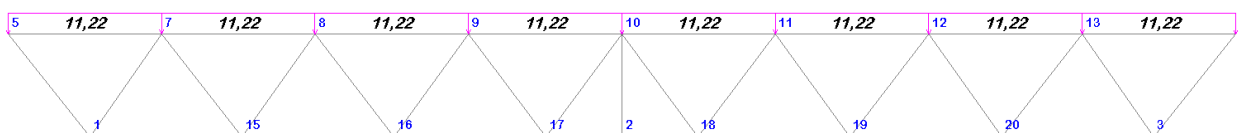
Воздействие распределенной постоянной нагрузки на верхний пояс стропильной фермы
